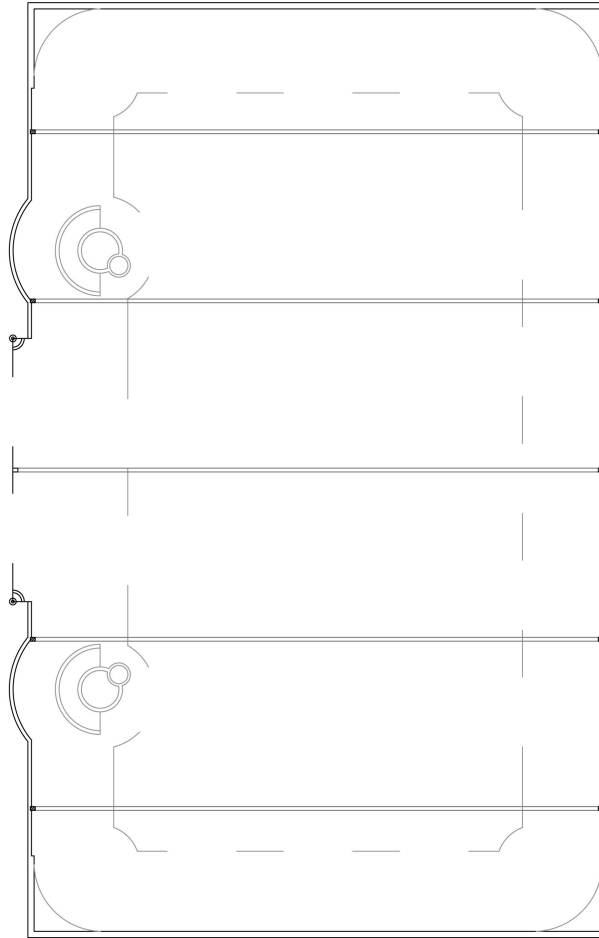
Propuesta de planta con cercha separadas 13,5 metros bi-apoyadas en pilares empotrados.
